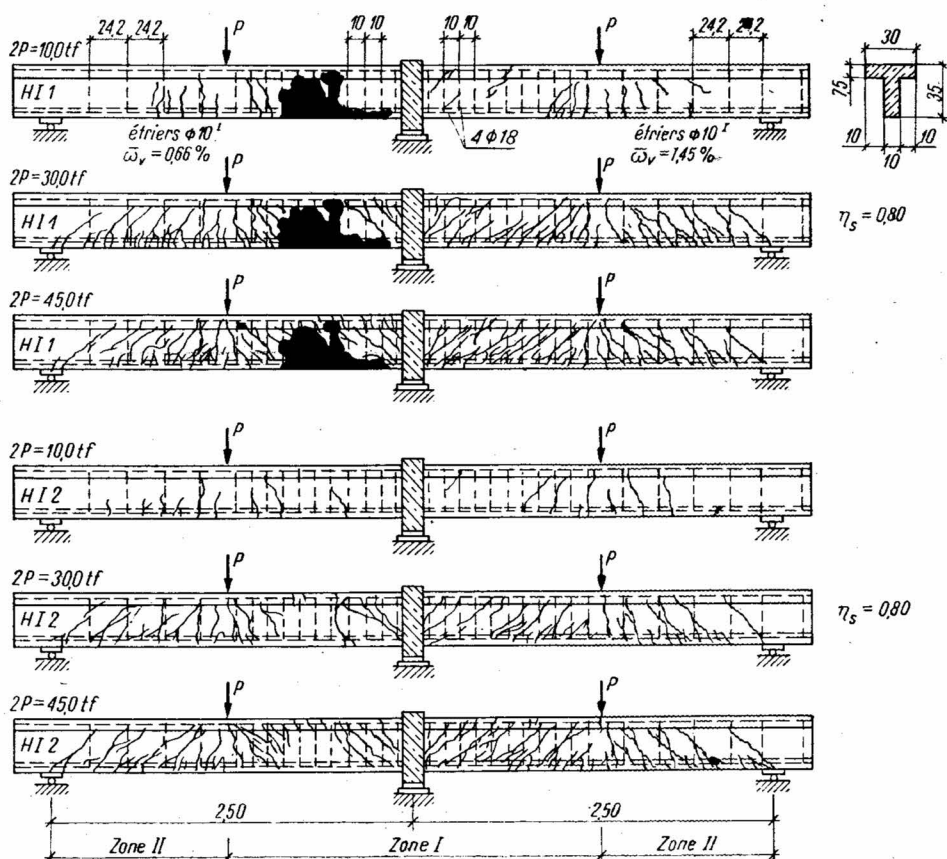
Fissuration des poutres *HI1* et *HI2* d'après [56]
